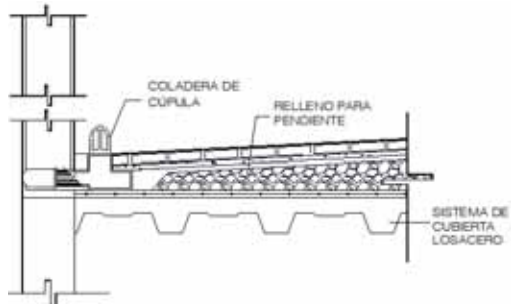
Solución con coladera de cúpula para sistema de cubierta losacero.
